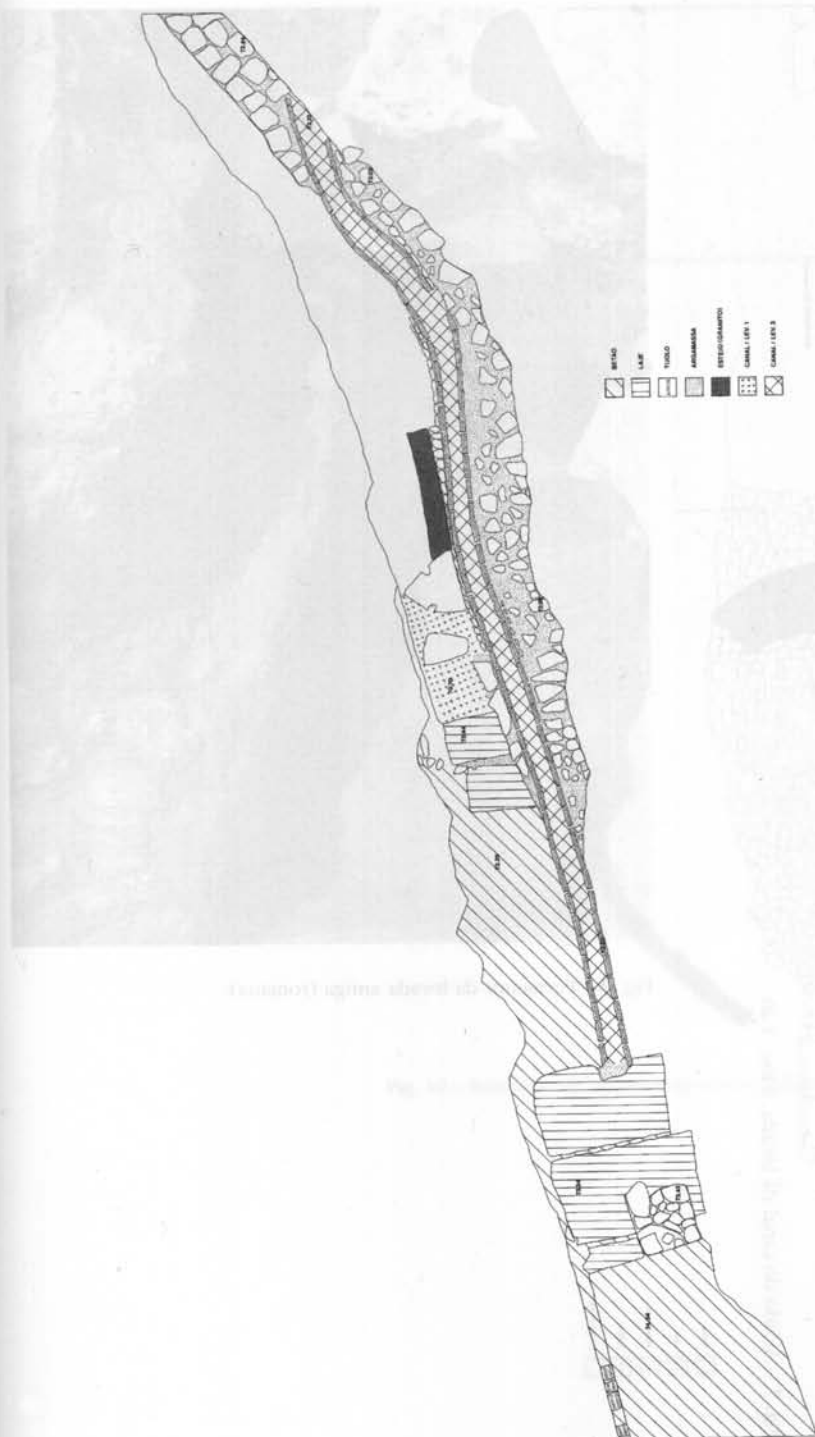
Plano do canal da levada, à Esc. 1:20.
